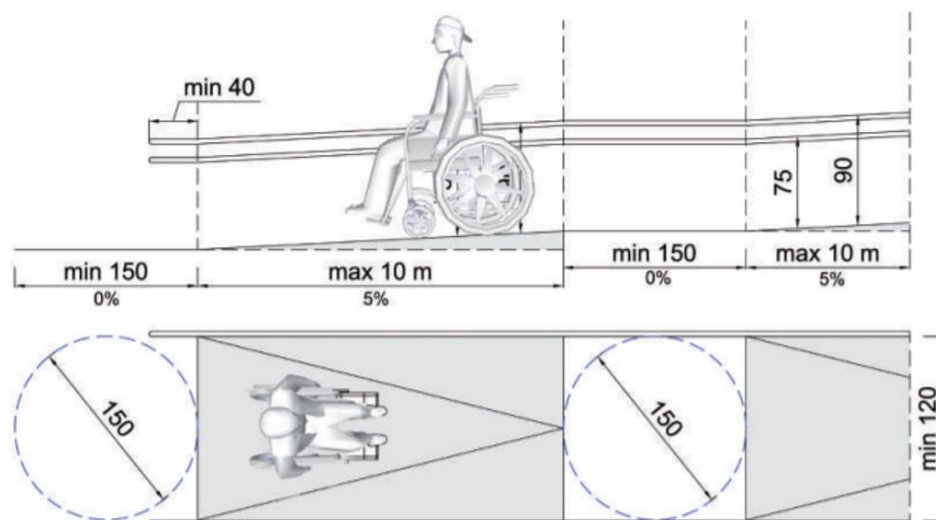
Normes de conception d'une pente accessible, Source : Guide pour la construction d'un bâtiment accessible
